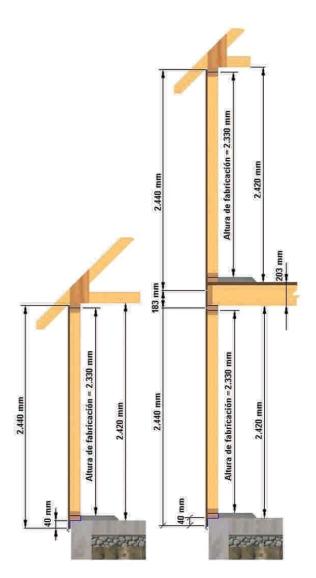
76: Altura de fabricación de tabiques con madera cepillada sobre plataforma de hormigón para el caso de viviendas de 1 ó 2 pisos, considerando solera basal de montaje, sobrelosa afinada sobre el radier y loseta liviana acústica en 2º piso; ambas de 40 a 50 mm de espesor.
